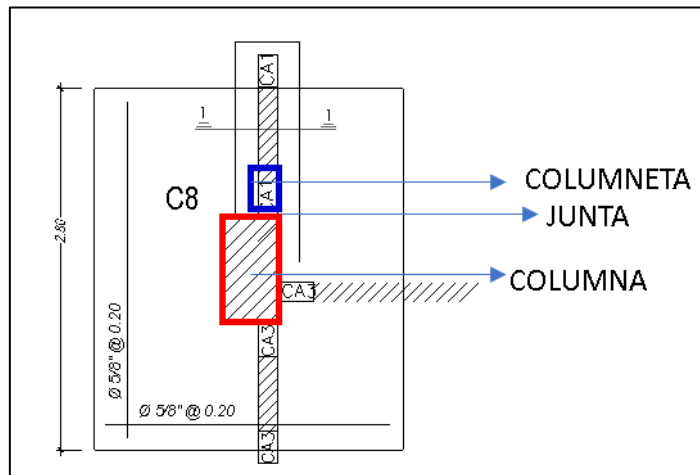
detalle de encuentro de columna, columnetas y junta en cimientos
